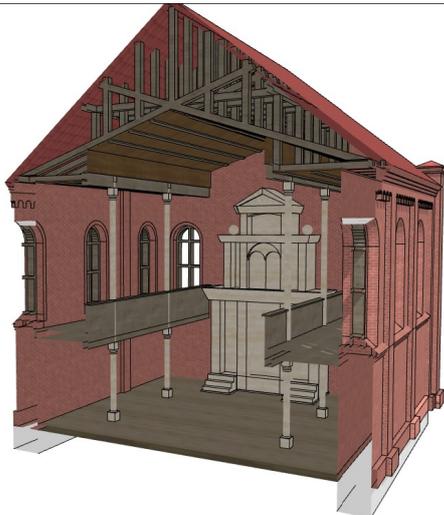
Schnitt, quer mit Einblick in die Dachbalken
